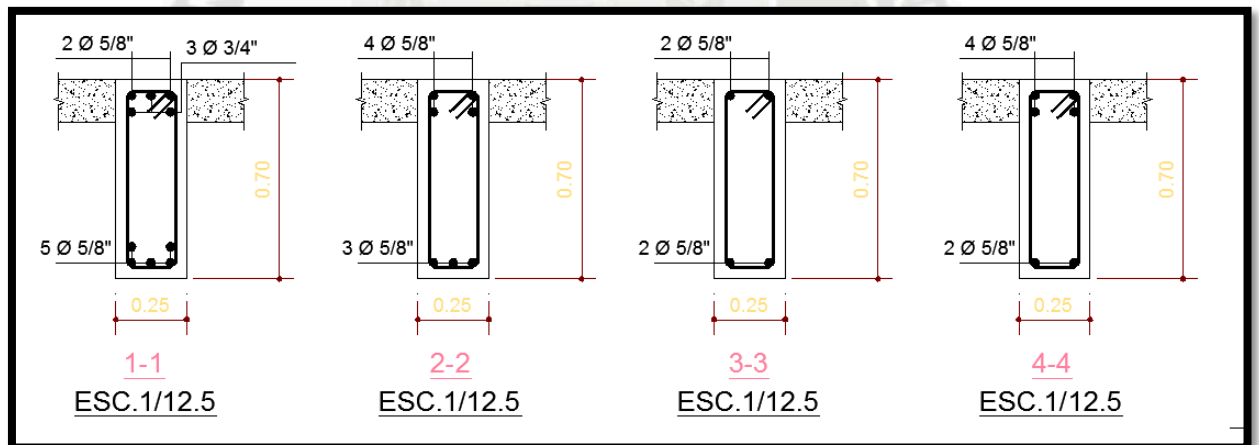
SECCIÓN DE VIGA V-111, V-112 Y V-113 BLOQUE B
